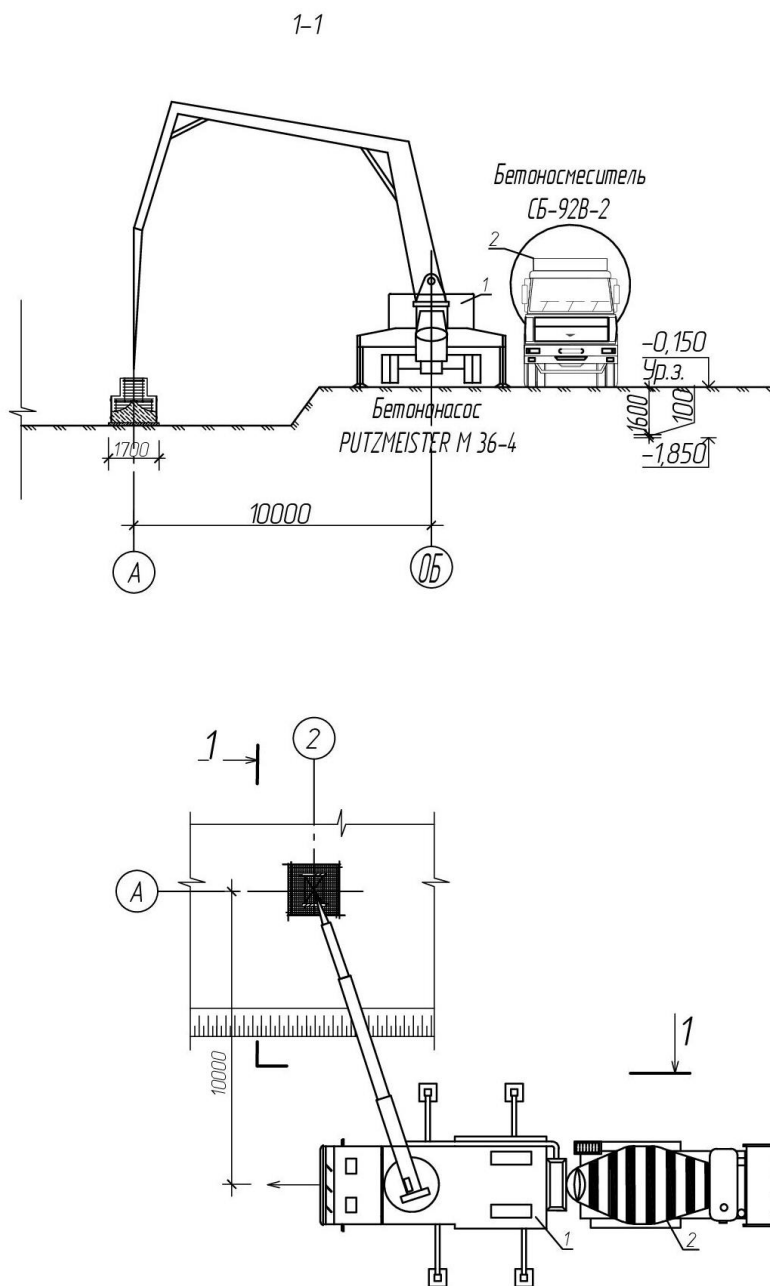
Схемы работ по устройству бетона при подаче бетонной смеси автобетононасосом
